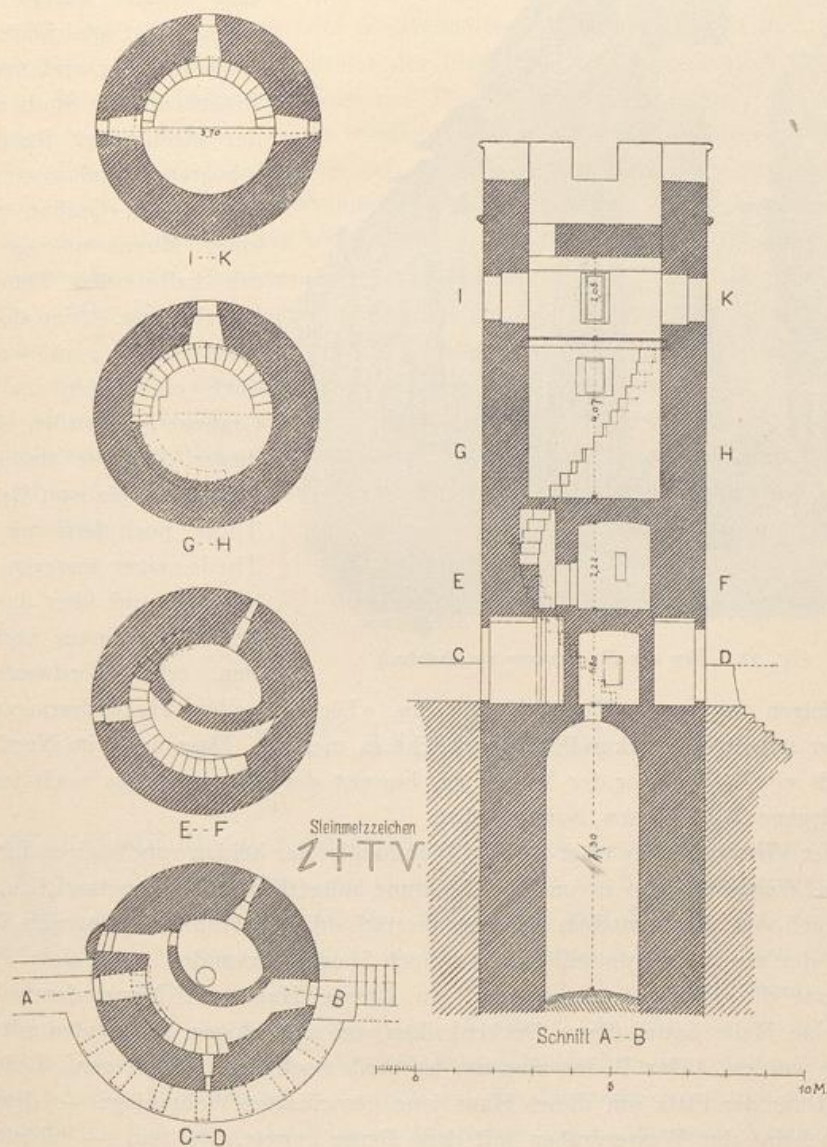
b. Durchschnitt und Grundrisse des Hexenthurms in Butzbach.
